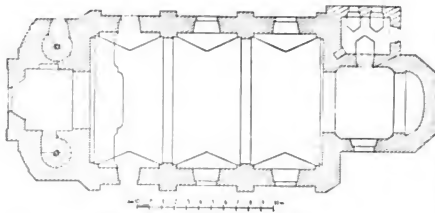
Wtelnó. Grundriss der Kirche.
